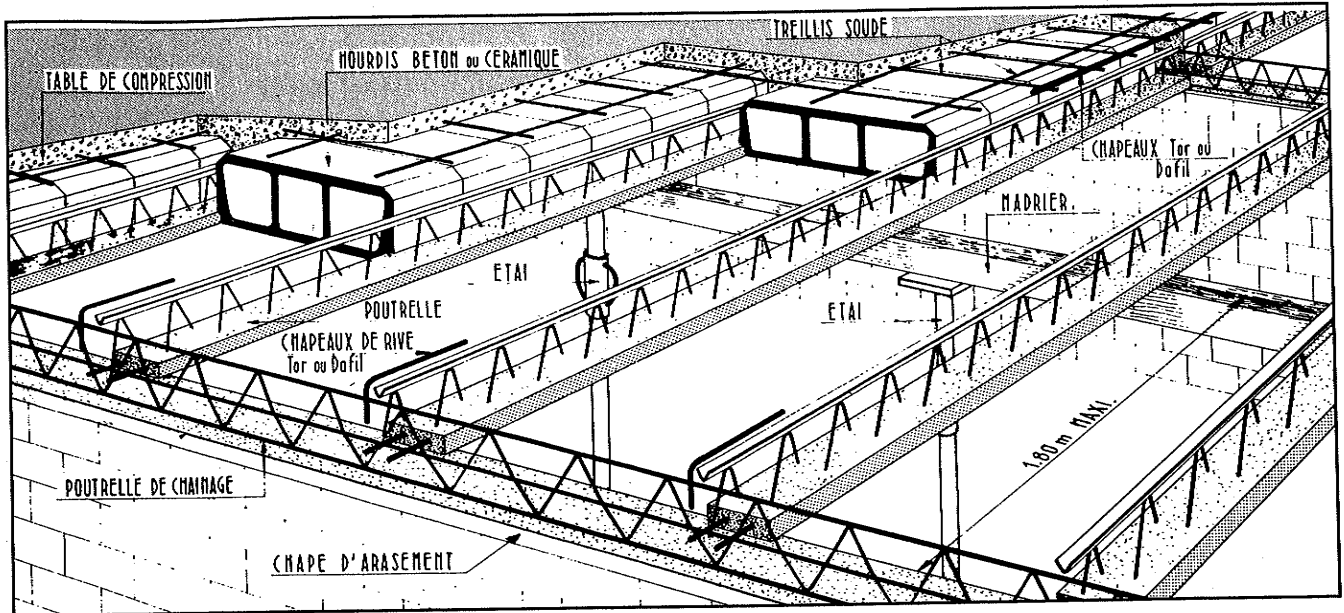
Vue d'ensemble d'un plancher avec poutrelles à treillis.
